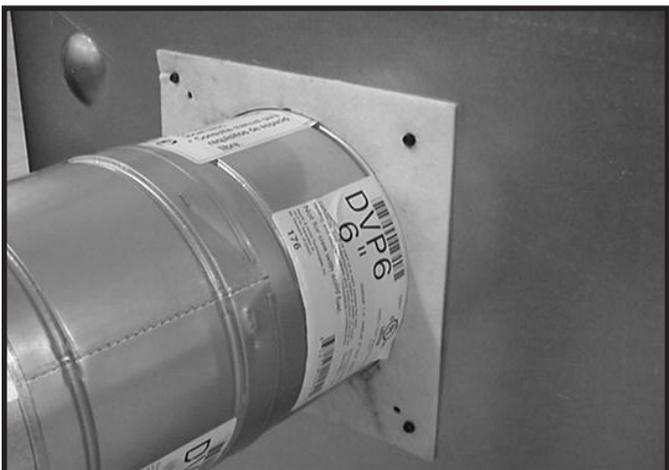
(foyer générique illustré) Posez la première section du conduit d'évacuation (elle se mettra en place avec un bruit sec). Glissez le joint d'isolation sur cette section du conduit, contre l'appareil, en passant sur les languettes. Utilisez les quatre vis autotaraudeuses pour fixer le joint à l'enveloppe extérieure.
